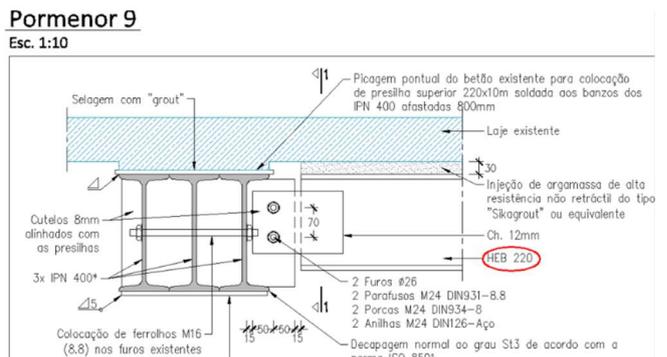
Divergência entre planta e pormenor do projeto de Estrutura
